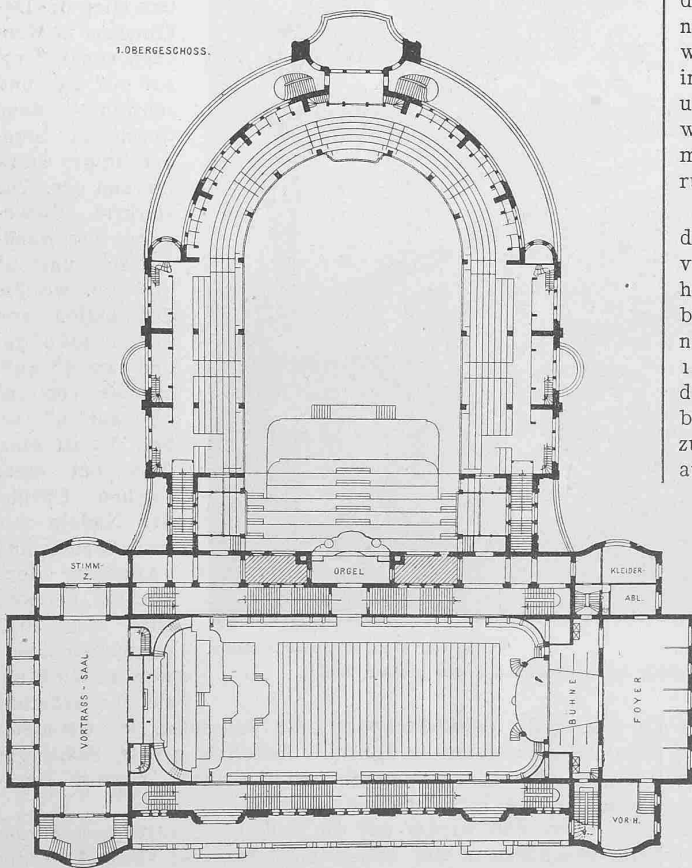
Grundriss vom I. Obergeschoss, Masstab 1:800.
